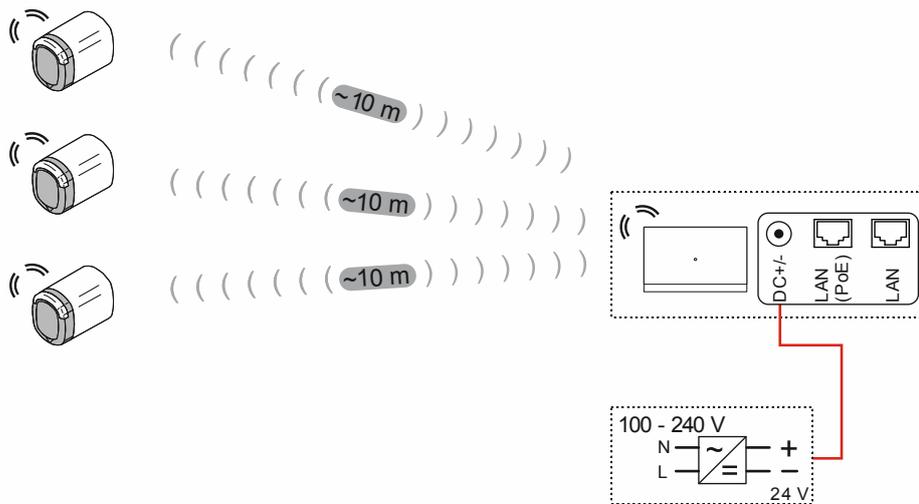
Conexión: edificio de viviendas con 3 "Cilindro de cierre electrónico"
